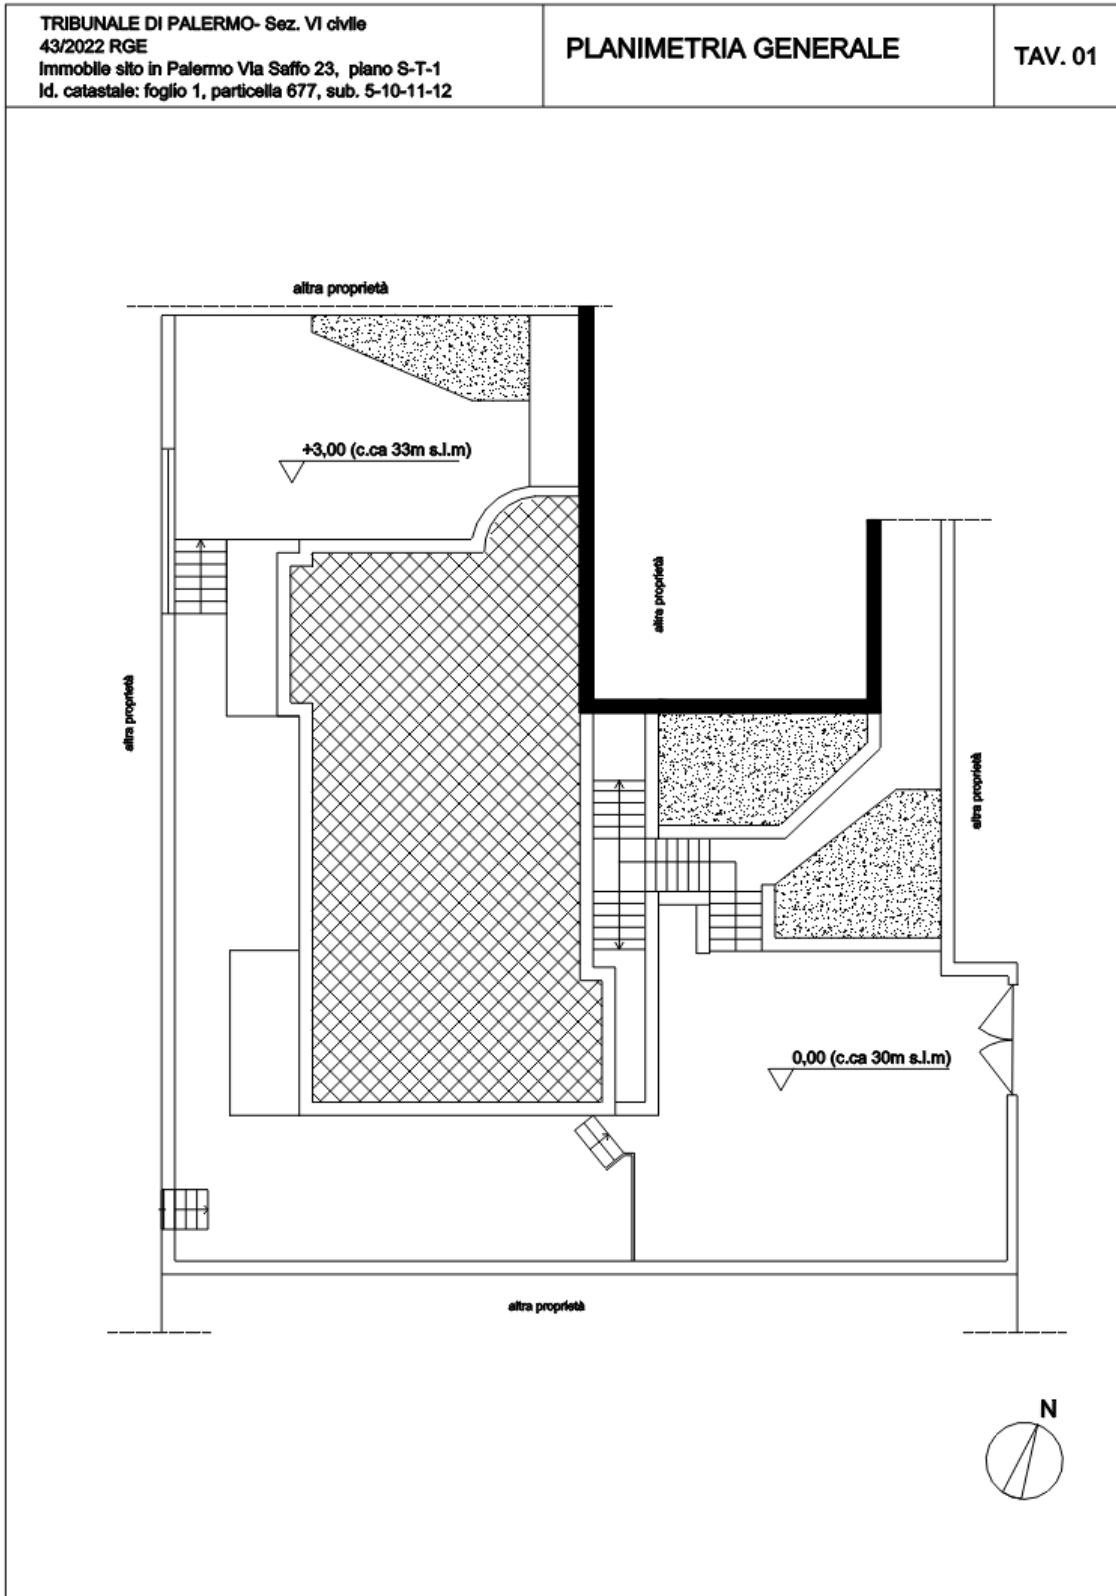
rilievo del 20/07-12/09-31/10/2023 planimetria generale
